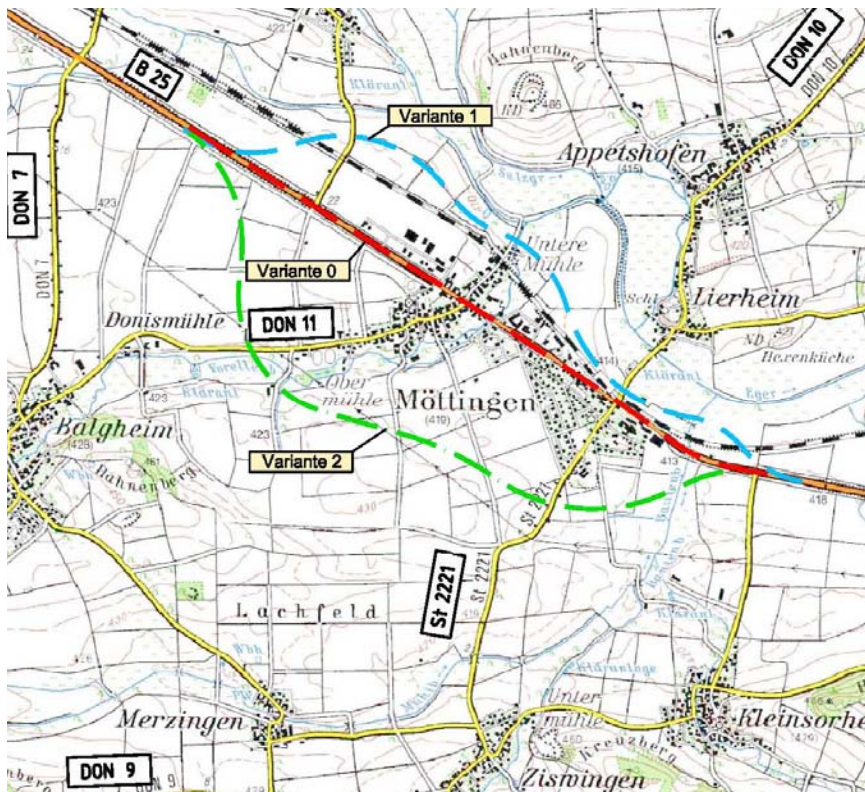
Lageplan – Variantenübersicht, unmaßstäblich
